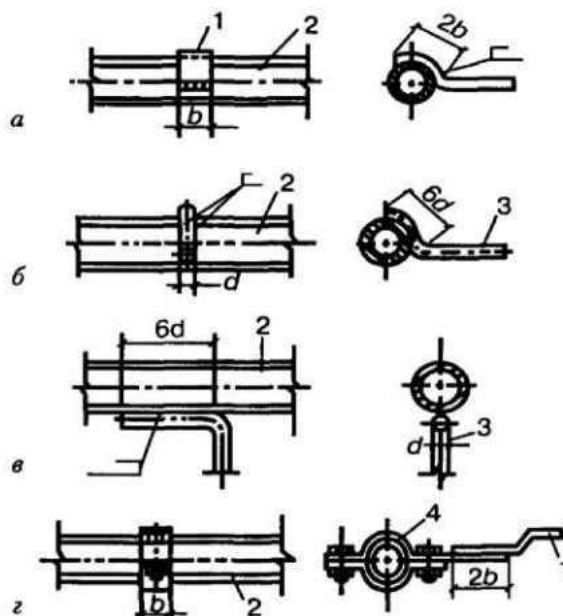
Присоединение заземляющего проводника к трубопроводу сваркой (а - в) и с помощью хомута (г); 1 - заземляющий проводник из полосовой стали; 2 - трубопровод; 3 - заземляющий проводник из круглой стали; 4 - хомут.
